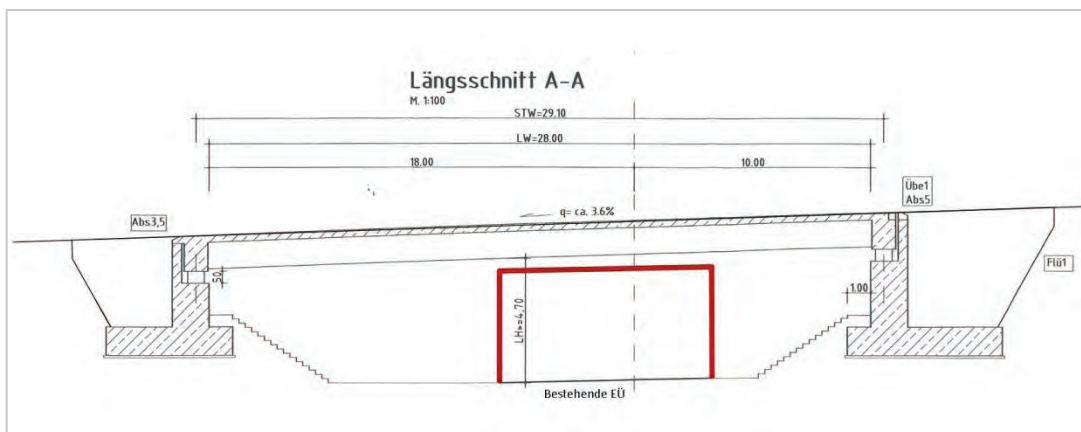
Bauwerksplan Landesbetrieb Straßenbau EÜ B8n
